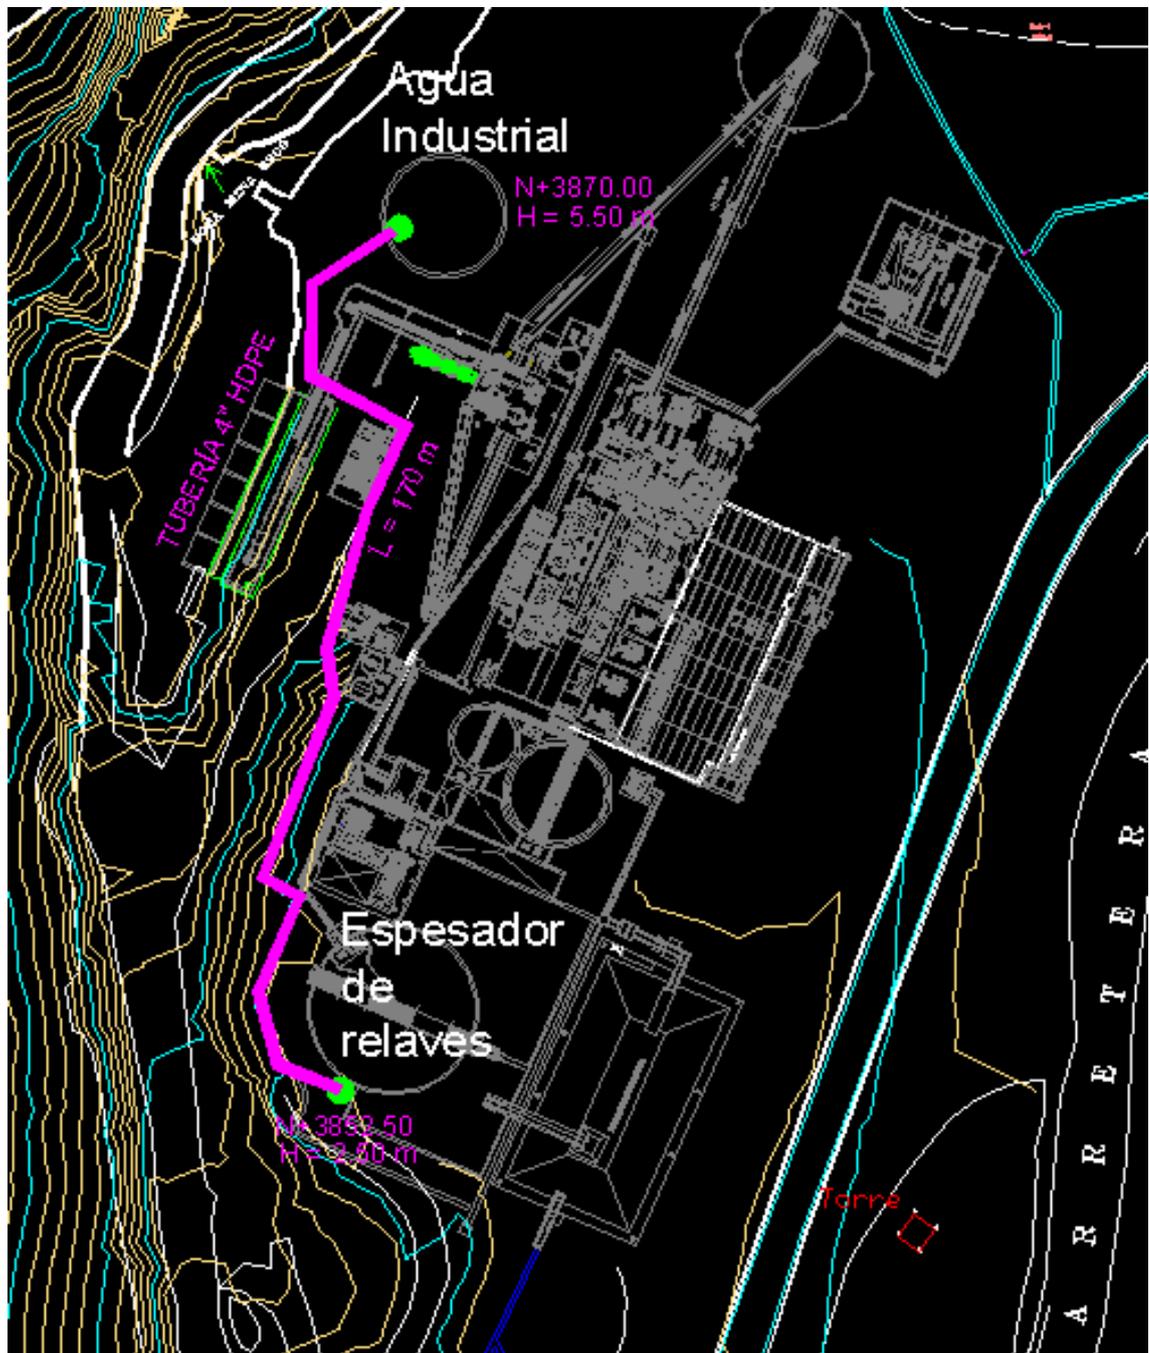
Plano de la Planta Concentradora Después de la Implementación
